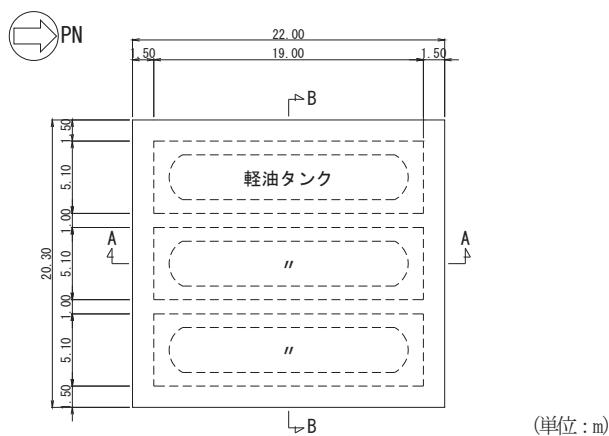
ガスタービン発電設備軽油タンク室平面図
